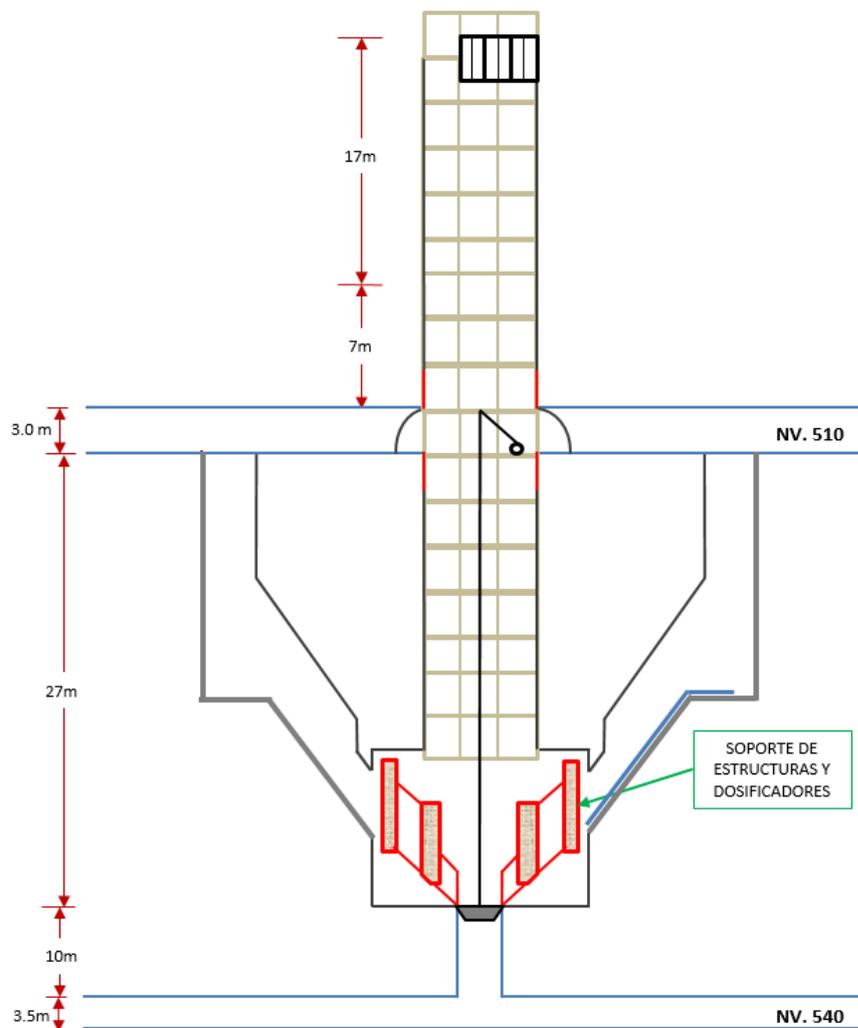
Obras civiles y montaje metal-mecánicos en Loading Pocket
